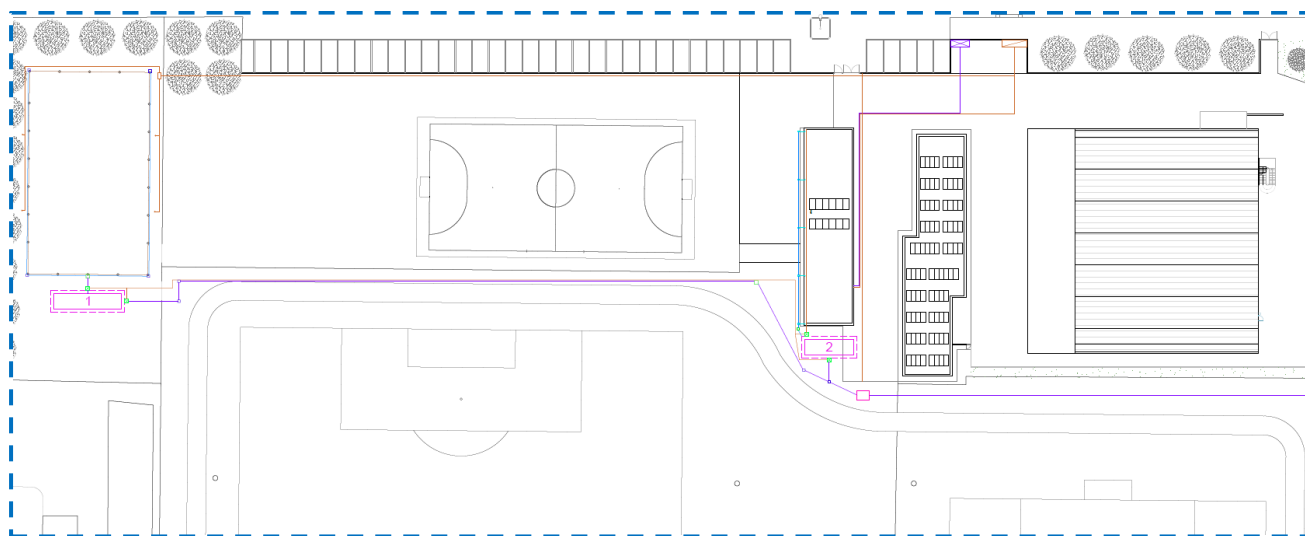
Estratto Tav.06 - Reti tecnologiche: planimetria generale
